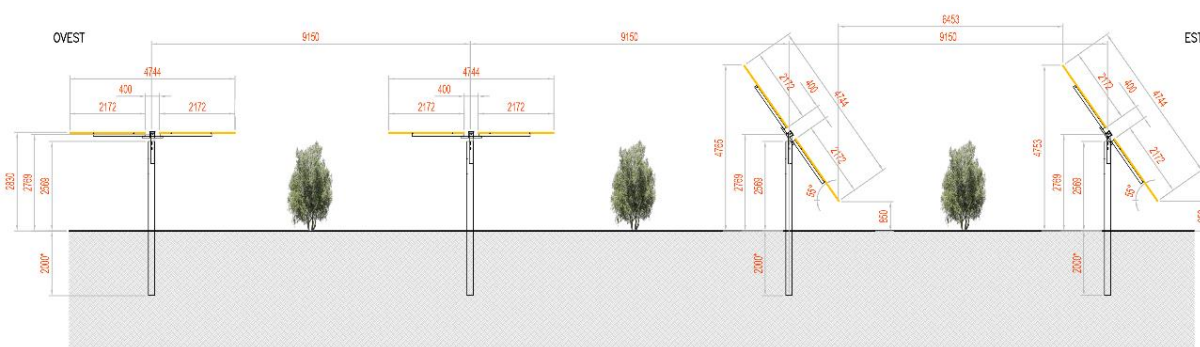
Tipologico – Vista Planimetrica dell’impianto Olivicolo
